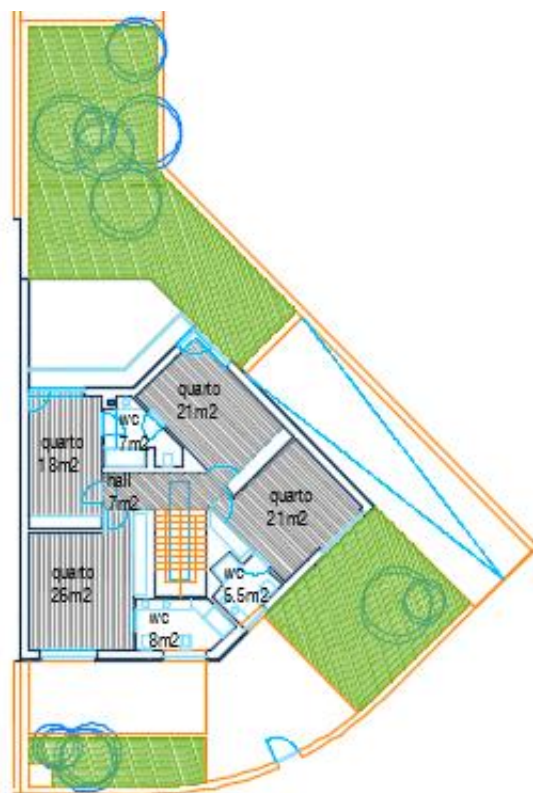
Planta do Piso 1 (Arquitetura).
